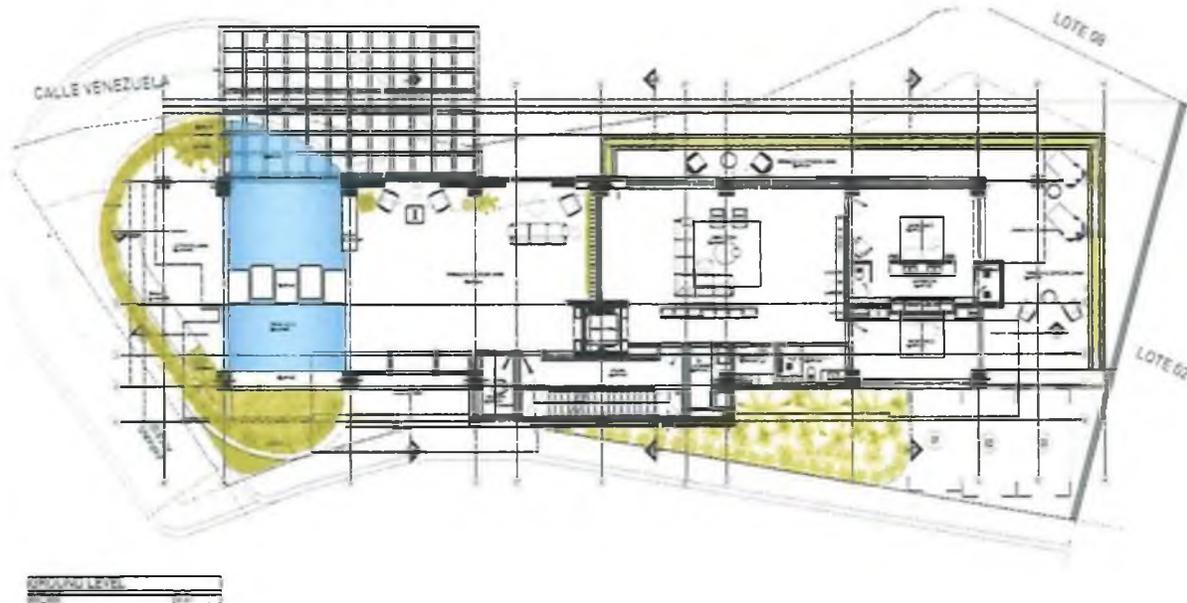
Planta Baja. Se presenta plano en anexos del estudio.
